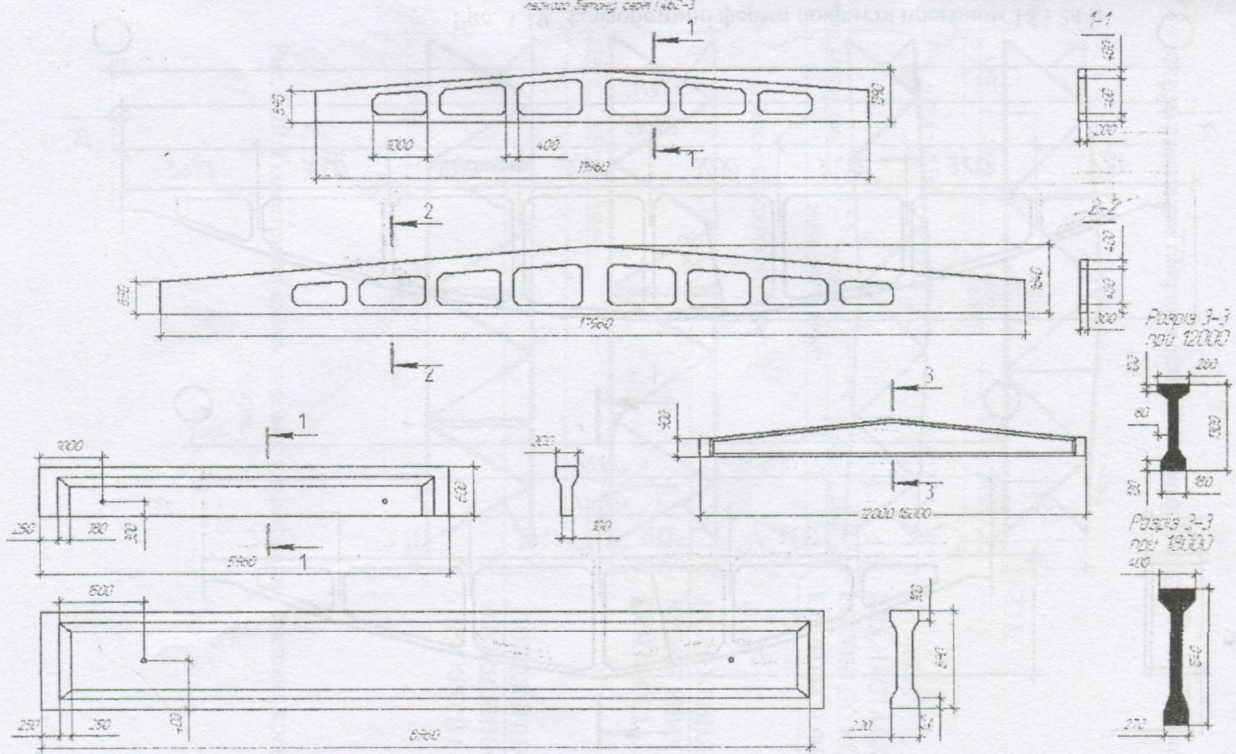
Залізобетонні балки покриття прогоном 6, 9 і 12 м
